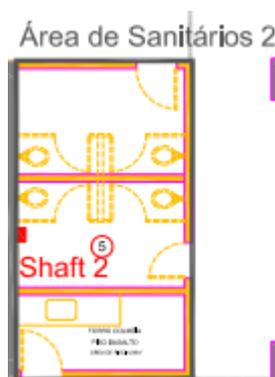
Planta de demolição – sanitário existente (3ºpavimento)
